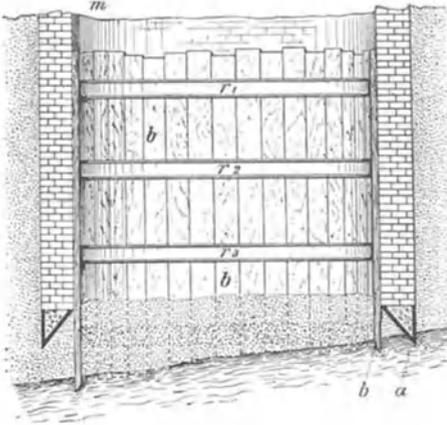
Senkrecht Anstecken in einem Senkschachte.
